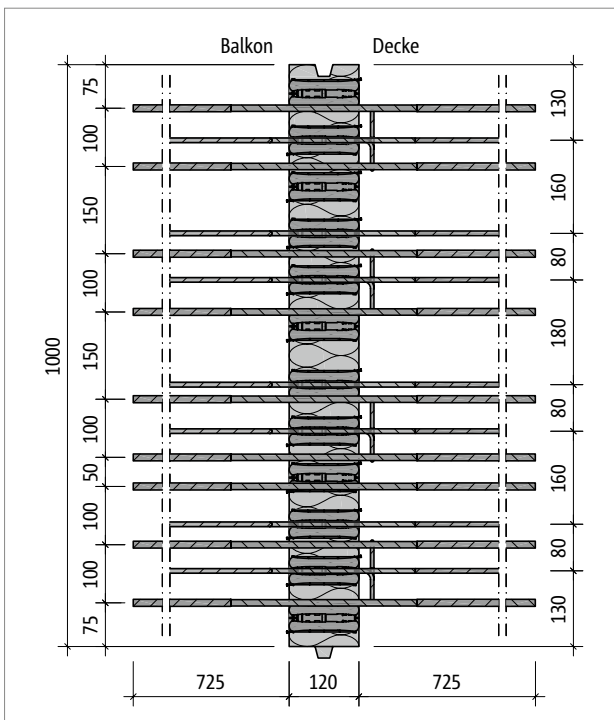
Schöck Isokorb® XT Typ KL-M8: Produktgrundriss
